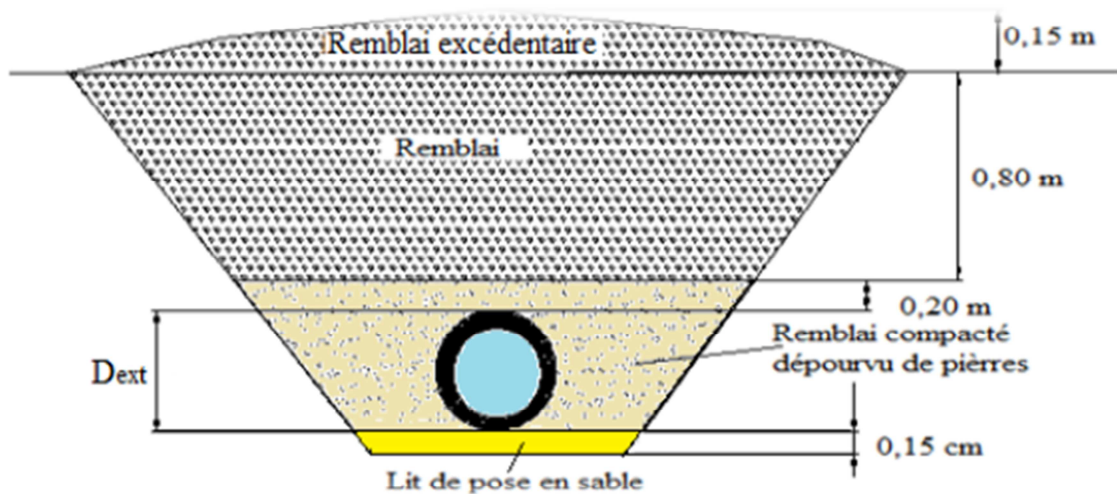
Coupe transversale d'une conduite enterrée.
